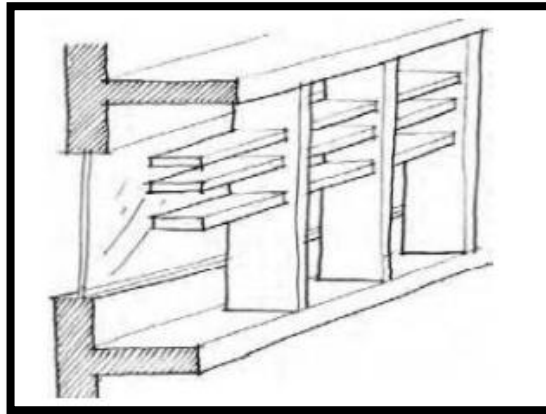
أنواع الكاسرات الأفقية، (Mechanical and Electrical Equipment for Buildings).
